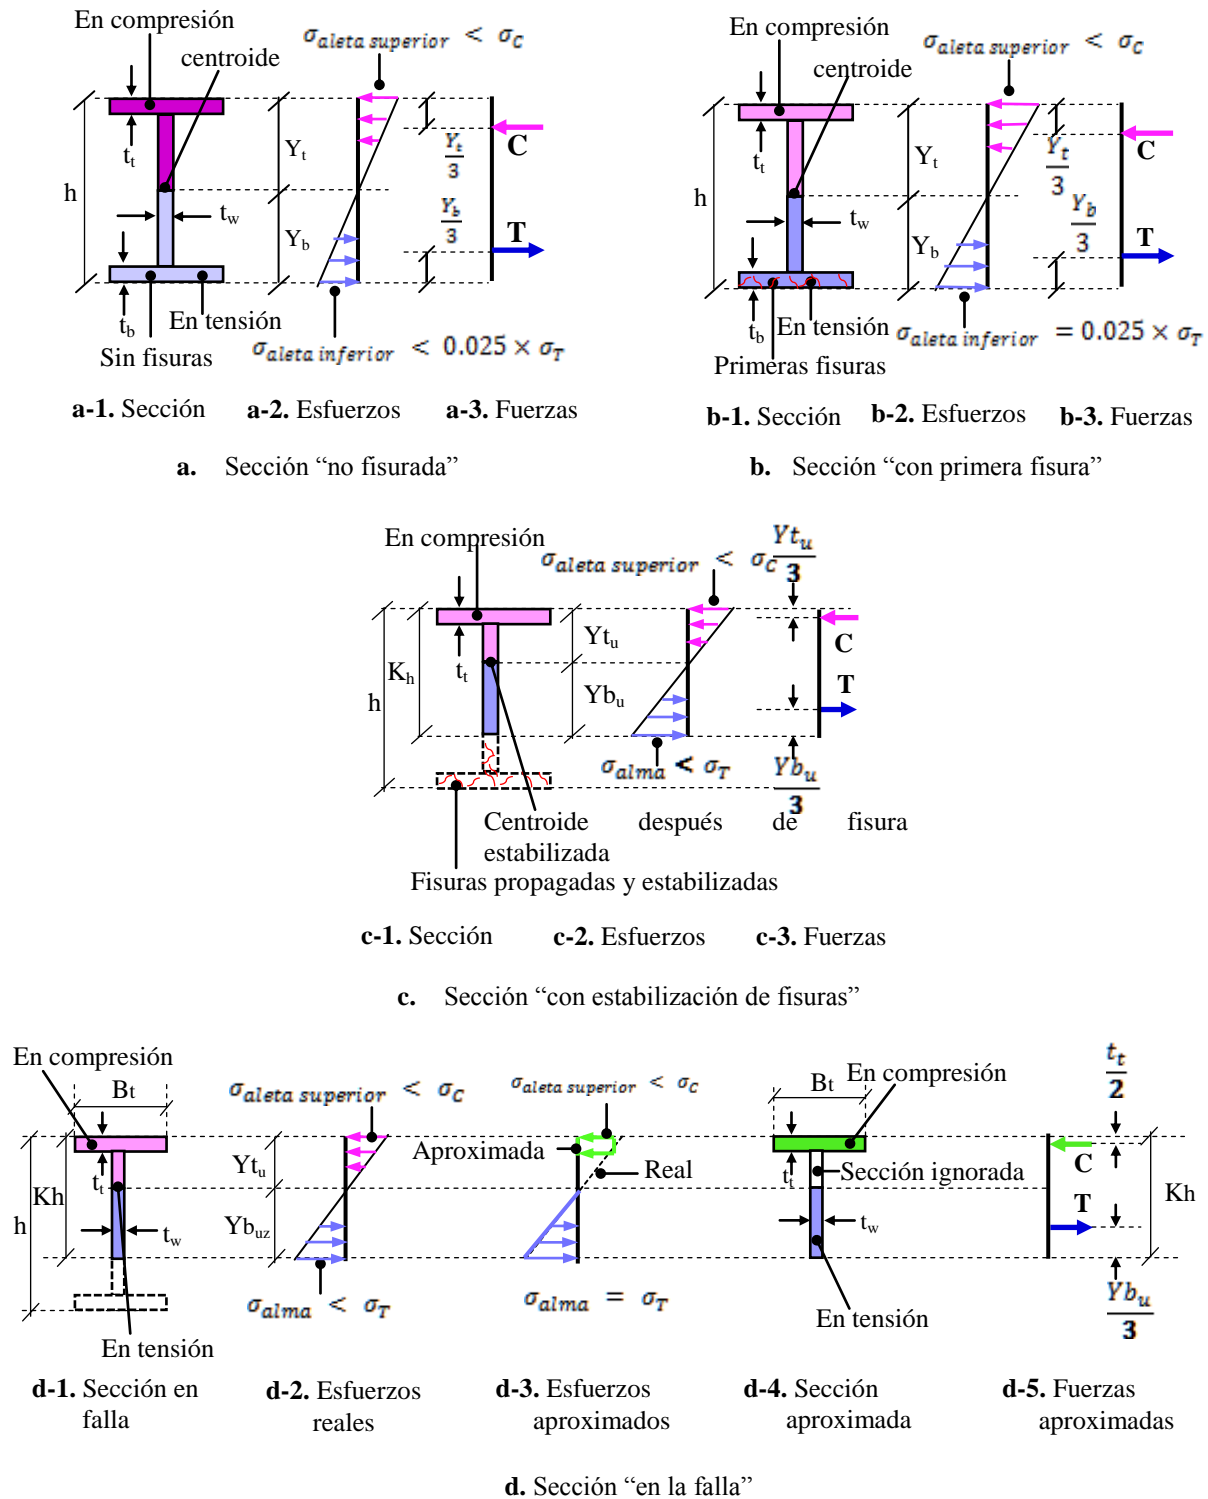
Distribución de esfuerzos y fuerzas, para la sección de la viga en el centro de la luz en las condiciones: "no fisurada", "con primeras fisuras", "con estabilización de fisuras" y "en la falla".
